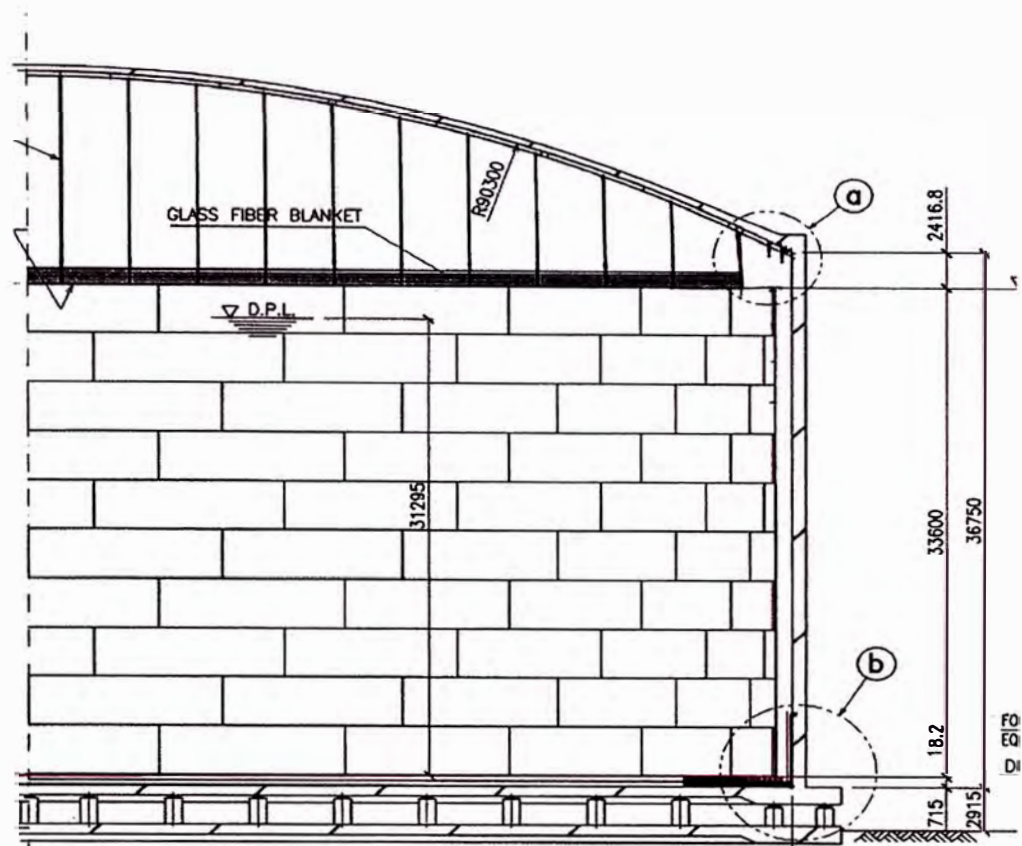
TANQUE CON ESQUINA DE PROTECCION
